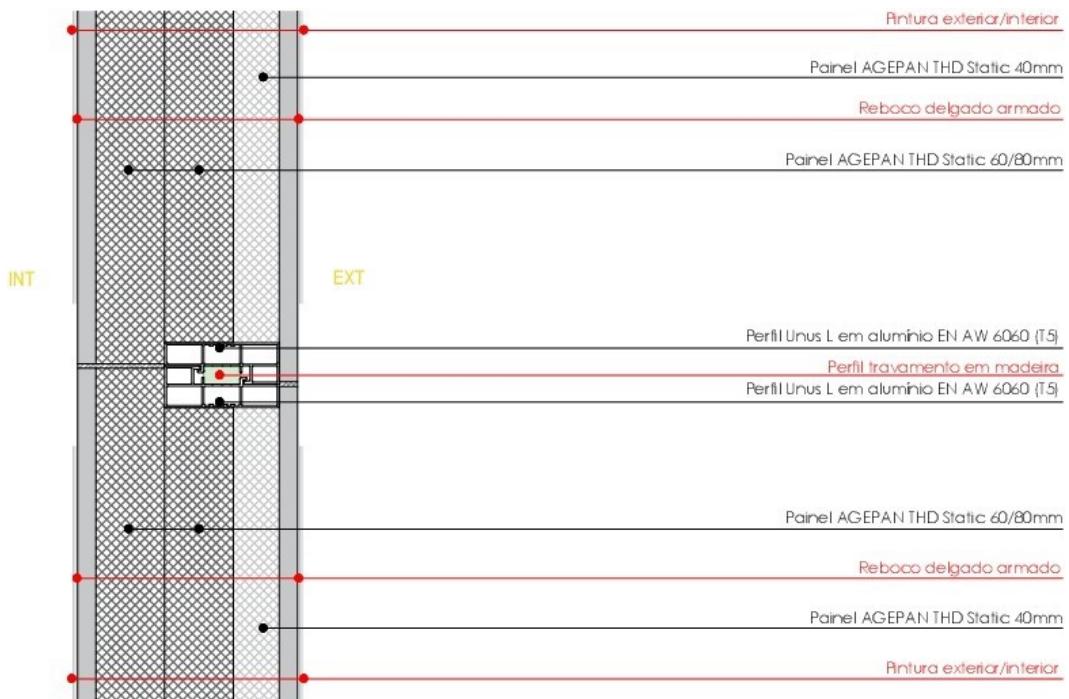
Solução AGEPLAN – Pormenor Construtivo de Paredes Verticais Consecutivas.
